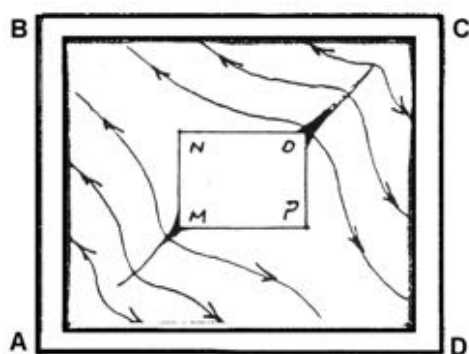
FISURAS EN BORDES DE HUECOS
